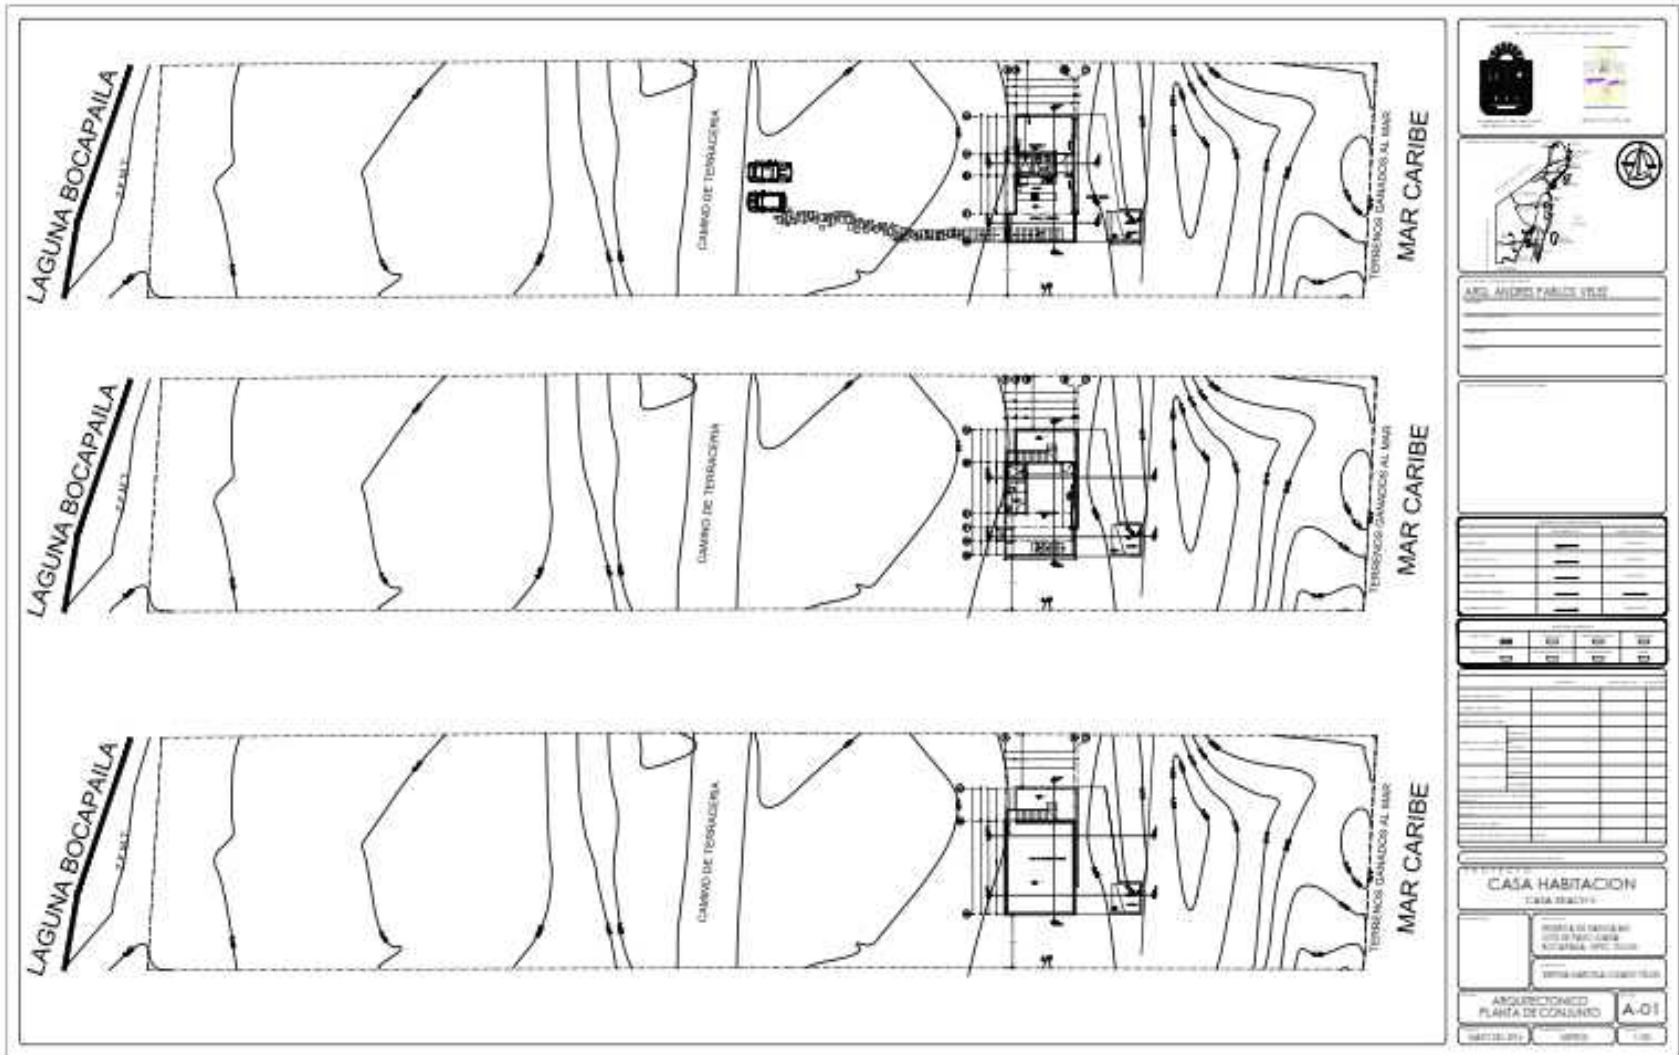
Plano de conjunto de proyecto “Casa Beach II”, lote 2E.
